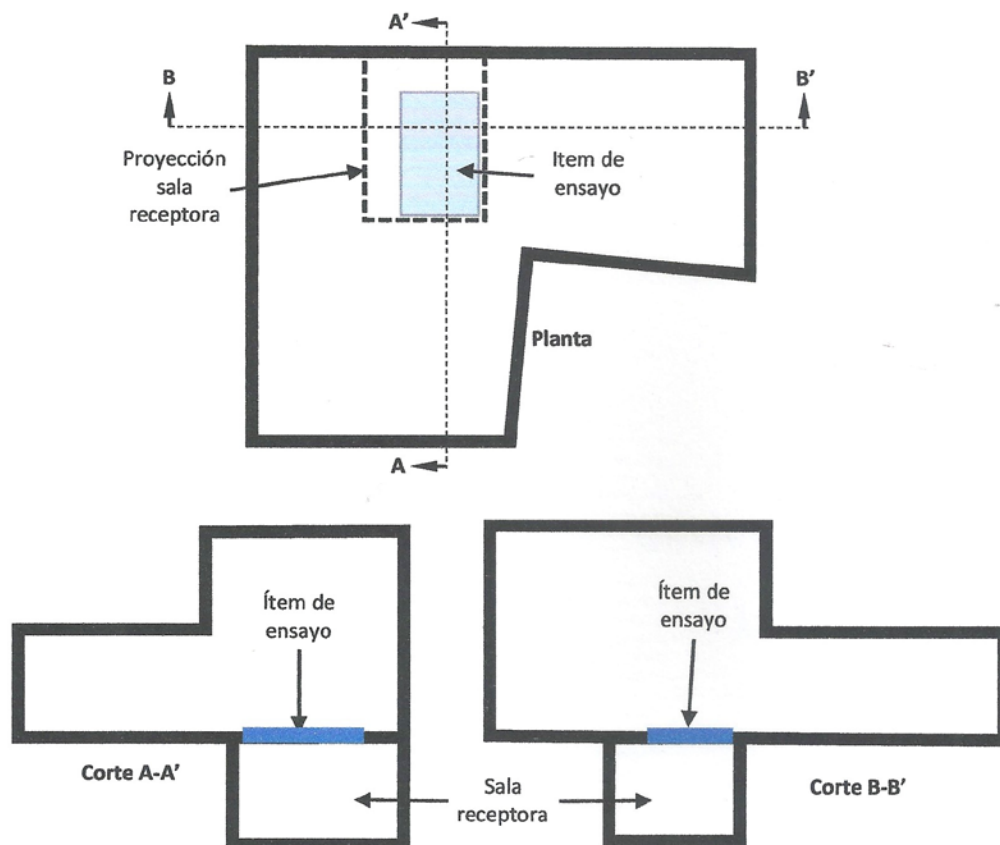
Esquema de planta y corte de los recintos de ensayo
